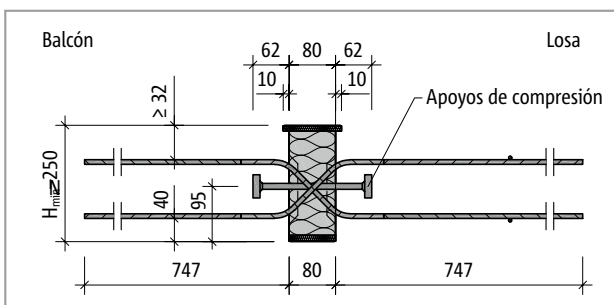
Schöck Isokorb® T tipo Q-P-VV8 hasta Q-P-VV9: Sección del producto
